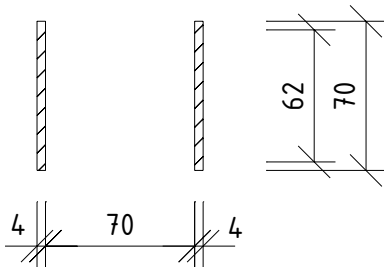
Pripevnenie koľajnice – ALT. 1
